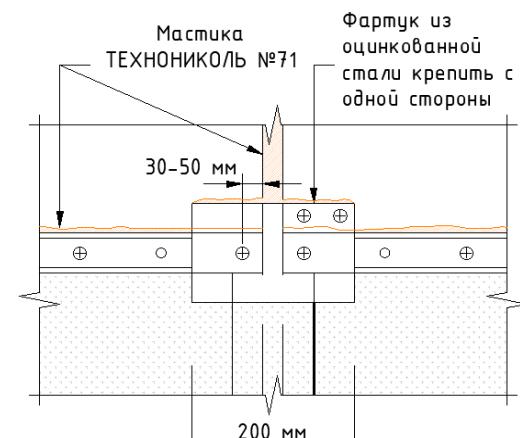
Краевая рейка на стене из бетонных панелей
